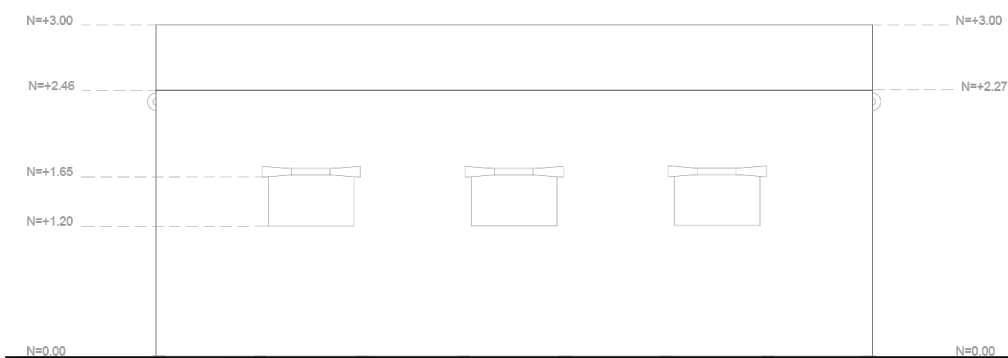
Elevación posterior del habitáculo Modular Emergency Plant. Fuente y elaboración: Autores.
